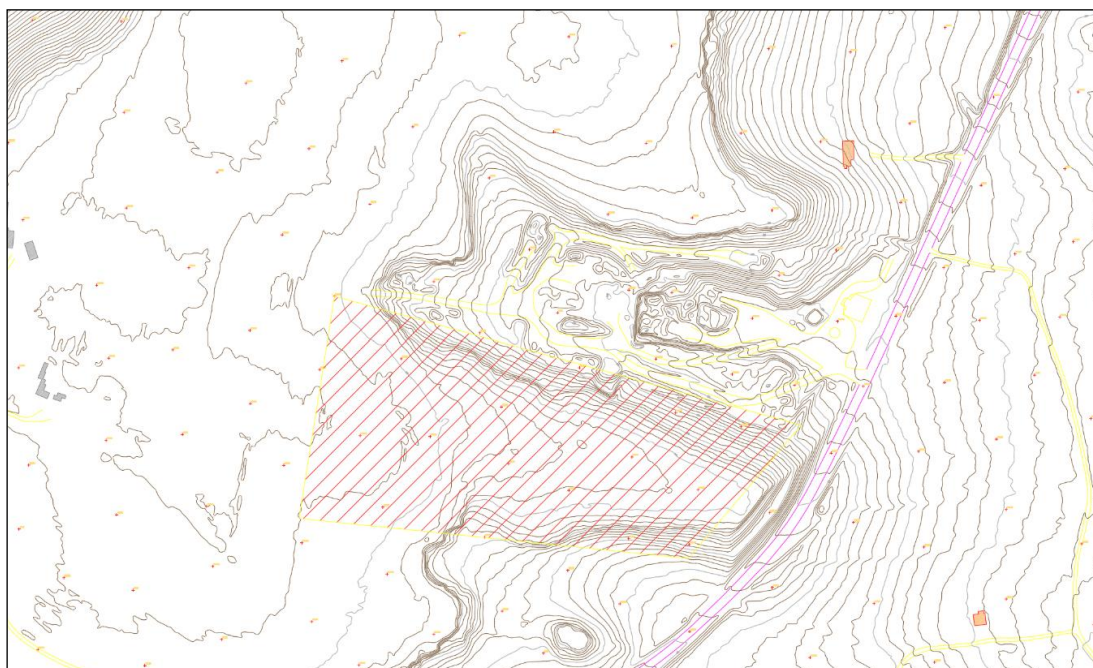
/B: Pianta estratta dal rilievo 2025 con tratteggio area su cui insisterà l'impianto
